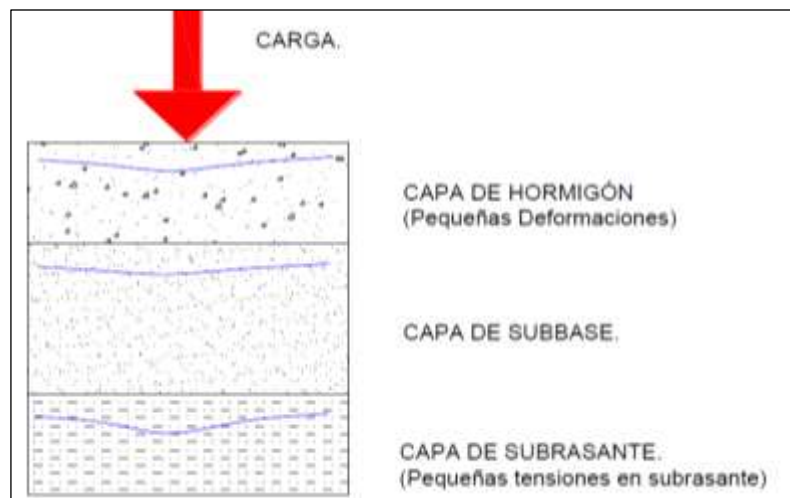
Perfil de pavimento rígido (Bernaola, 2014)
